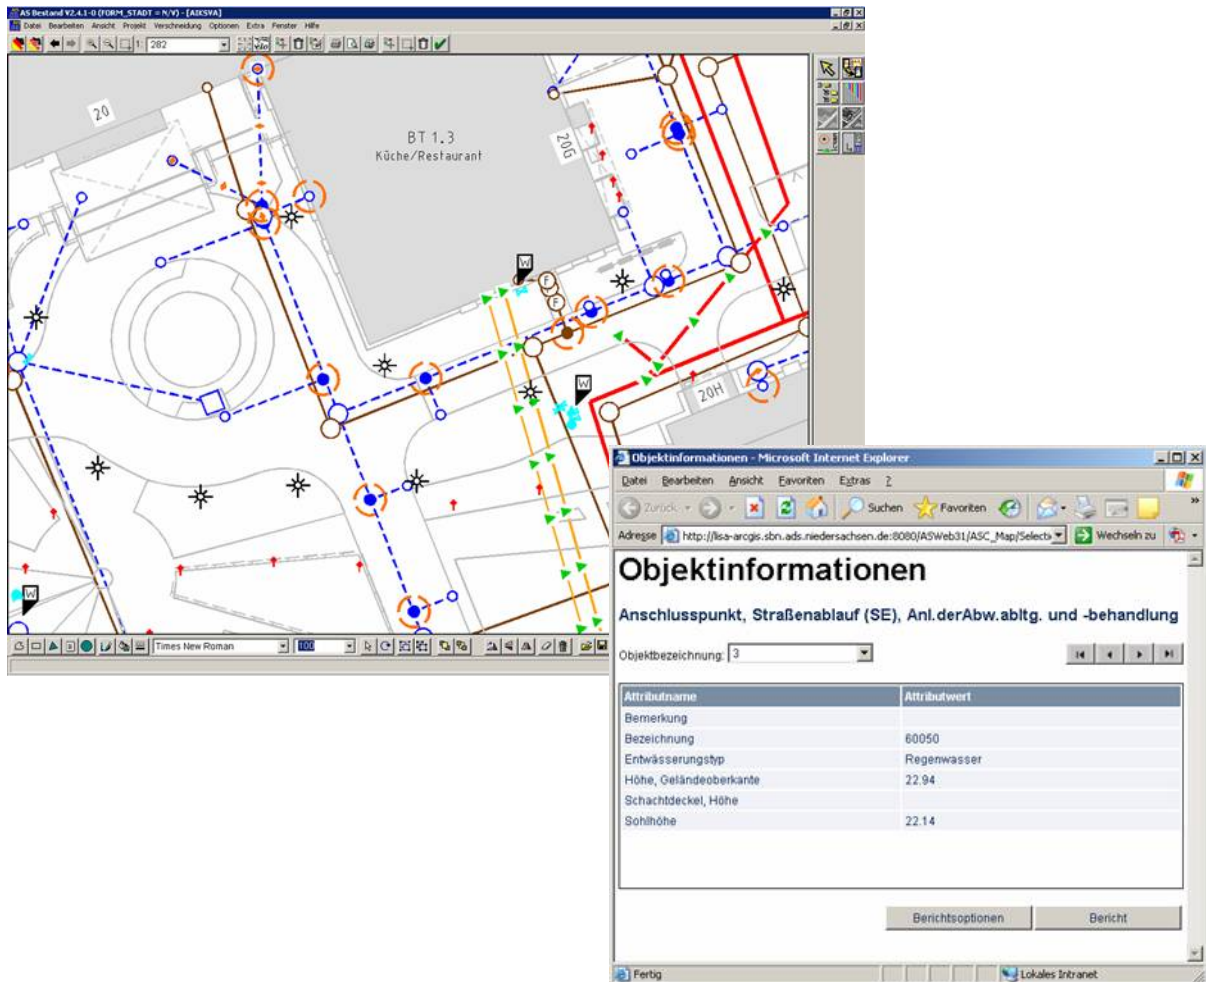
Fachplan und ausgegrauter Grundplan mit Anschluss an die Sachdatenkomponente
